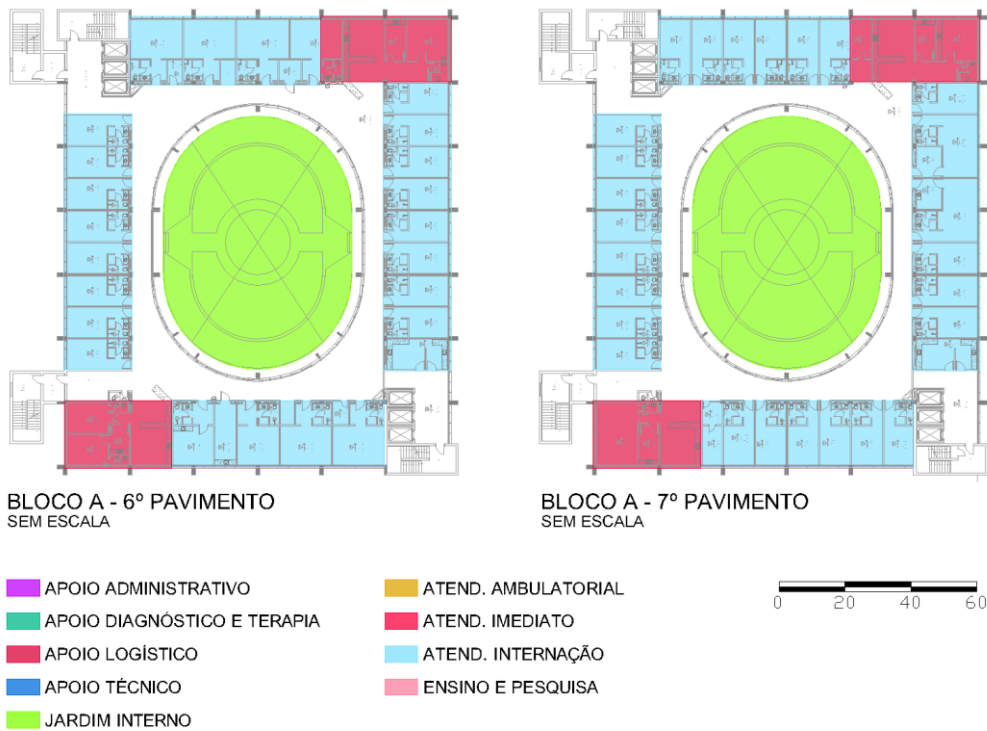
Setorização Bloco A, 6º e 7º pavimento
